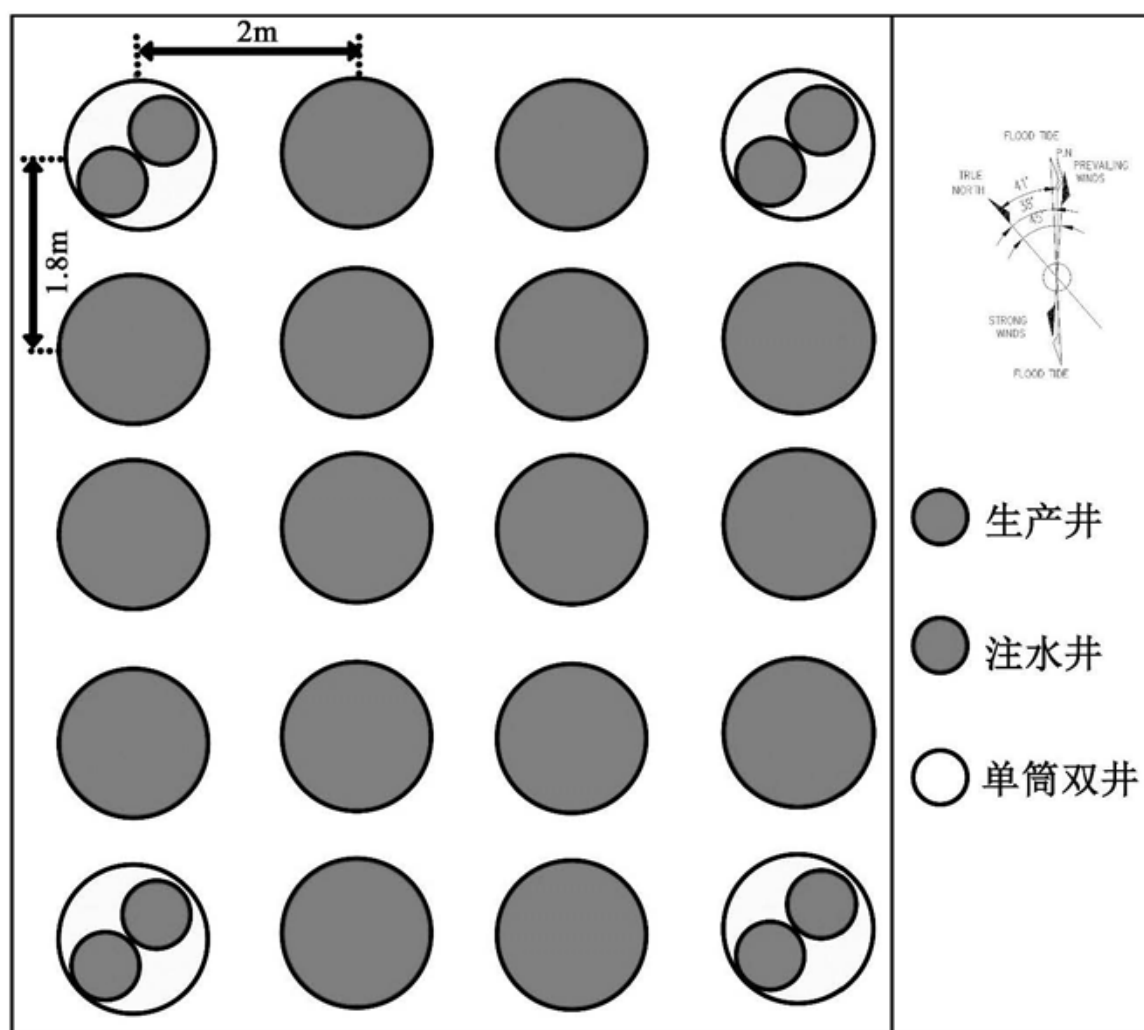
LD4-2 WHPC 平台井槽平面布置图
